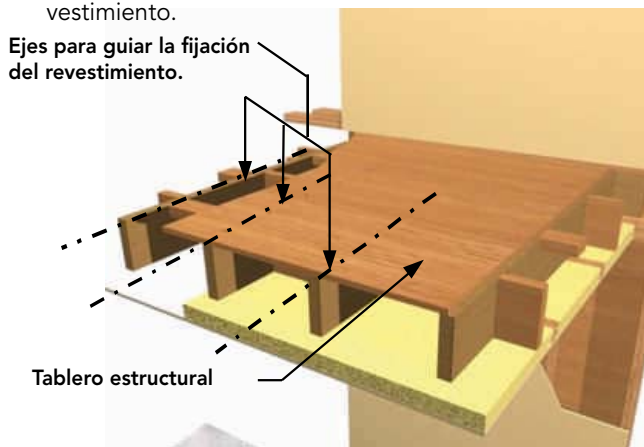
Trazado sobre el tablero base los ejes de las vigas secundarias.
